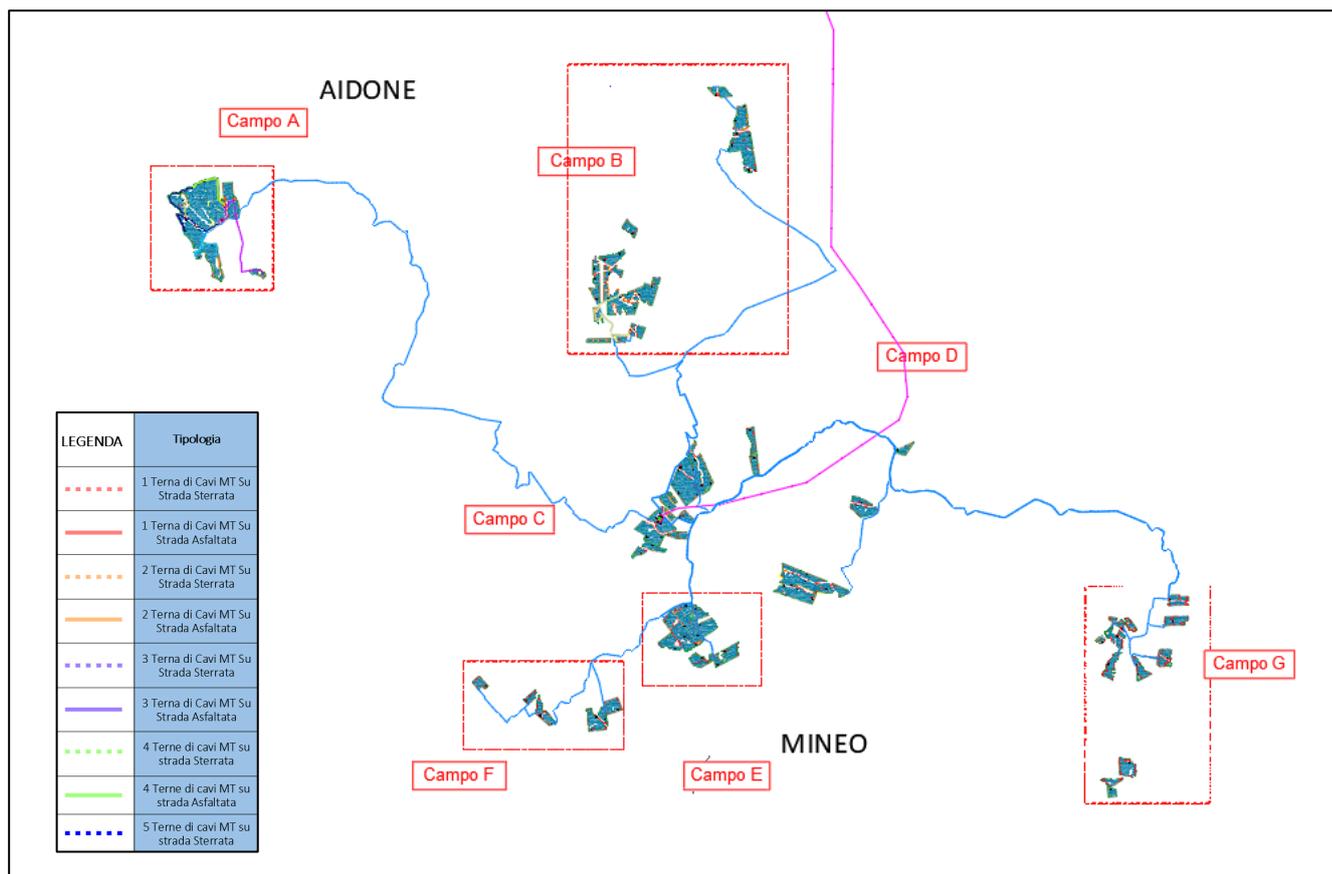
Layout Impianto con Cavidotti rif: "Tav CV.5 Planimetria impianto con tracciato cavidotti MT
